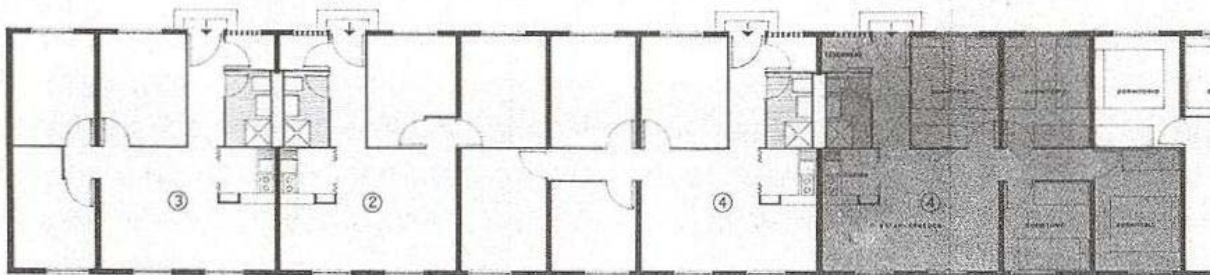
, 2 e 3 : UVA di Villaverde, il primo progetto. Prospetti, piante e foto aerea (3).
